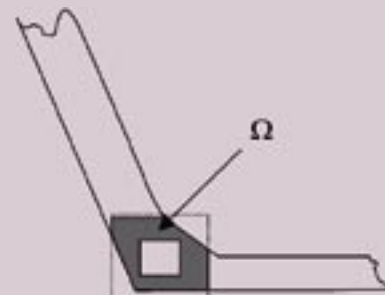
Ancrage en section intermédiaire – section de béton participantes
